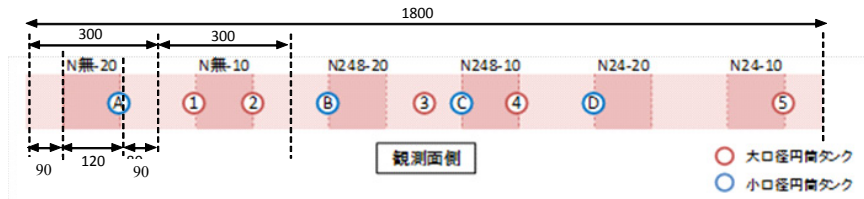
5種類の局所沈下実験用 BMS 層の現場配置図
